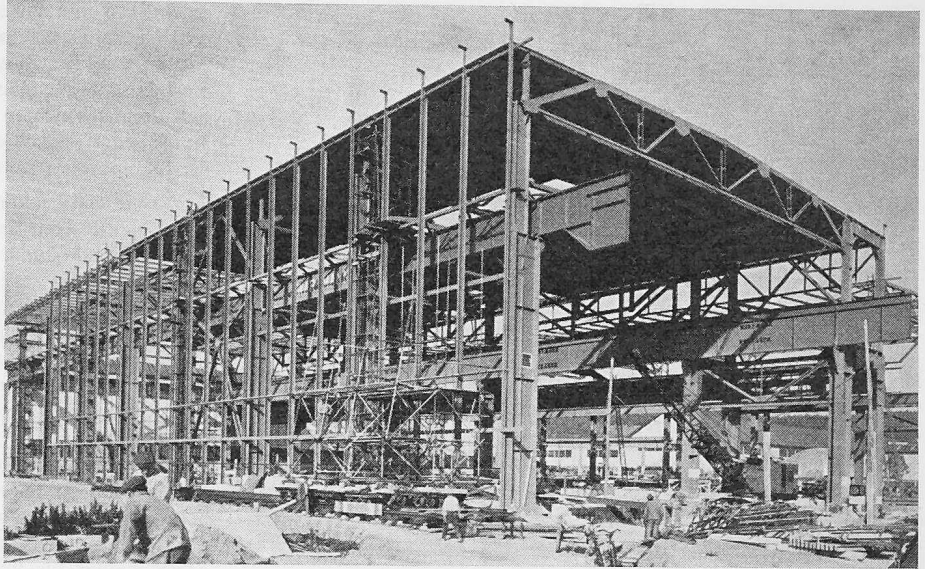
Montage der Stahlkonstruktion, vorn die Pressehalle
